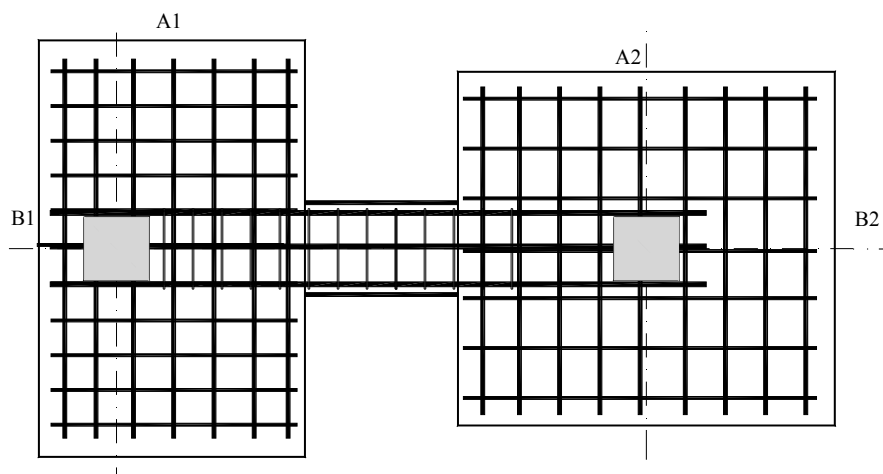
Modelo 2. Zapata excéntrica con viga centradora. Patrón Armado I
